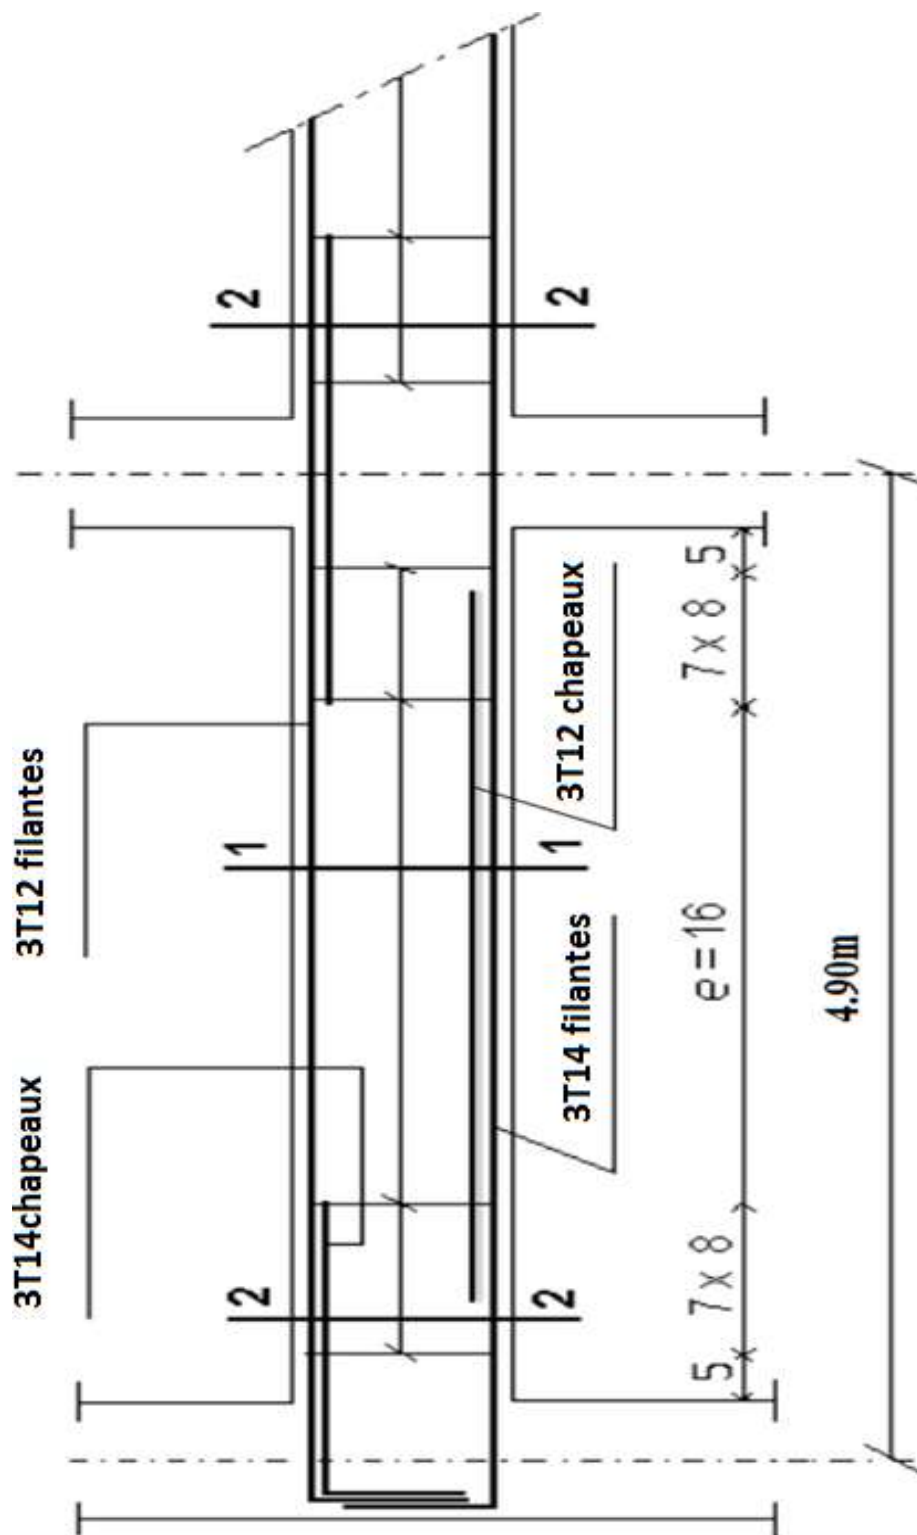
ferrailage des poutres principales et secondaires de RDC
